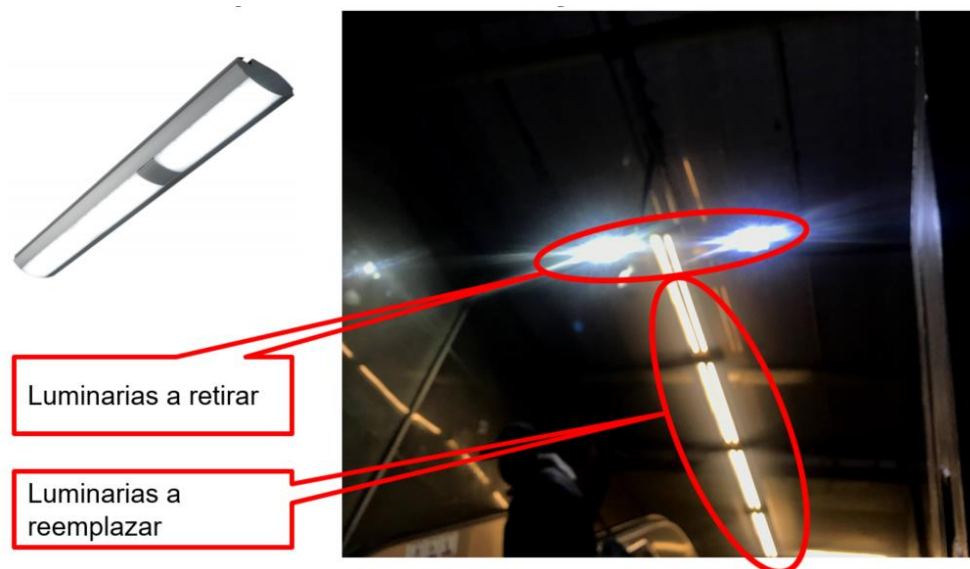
Interior Accesos Norte y Sur – Tipo
